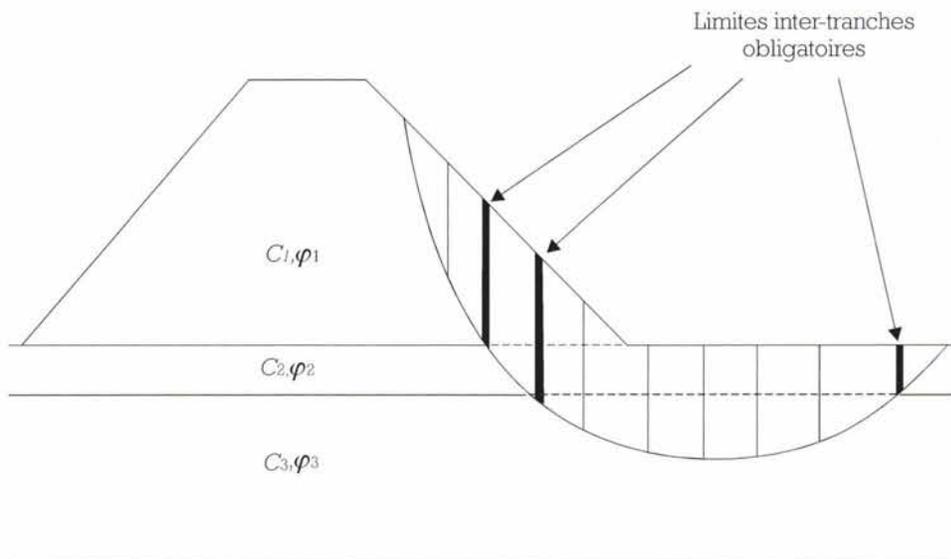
Exemple de découpage en tranches pour l'étude d'un cercle de glissement interceptant deux couches de fondation.
